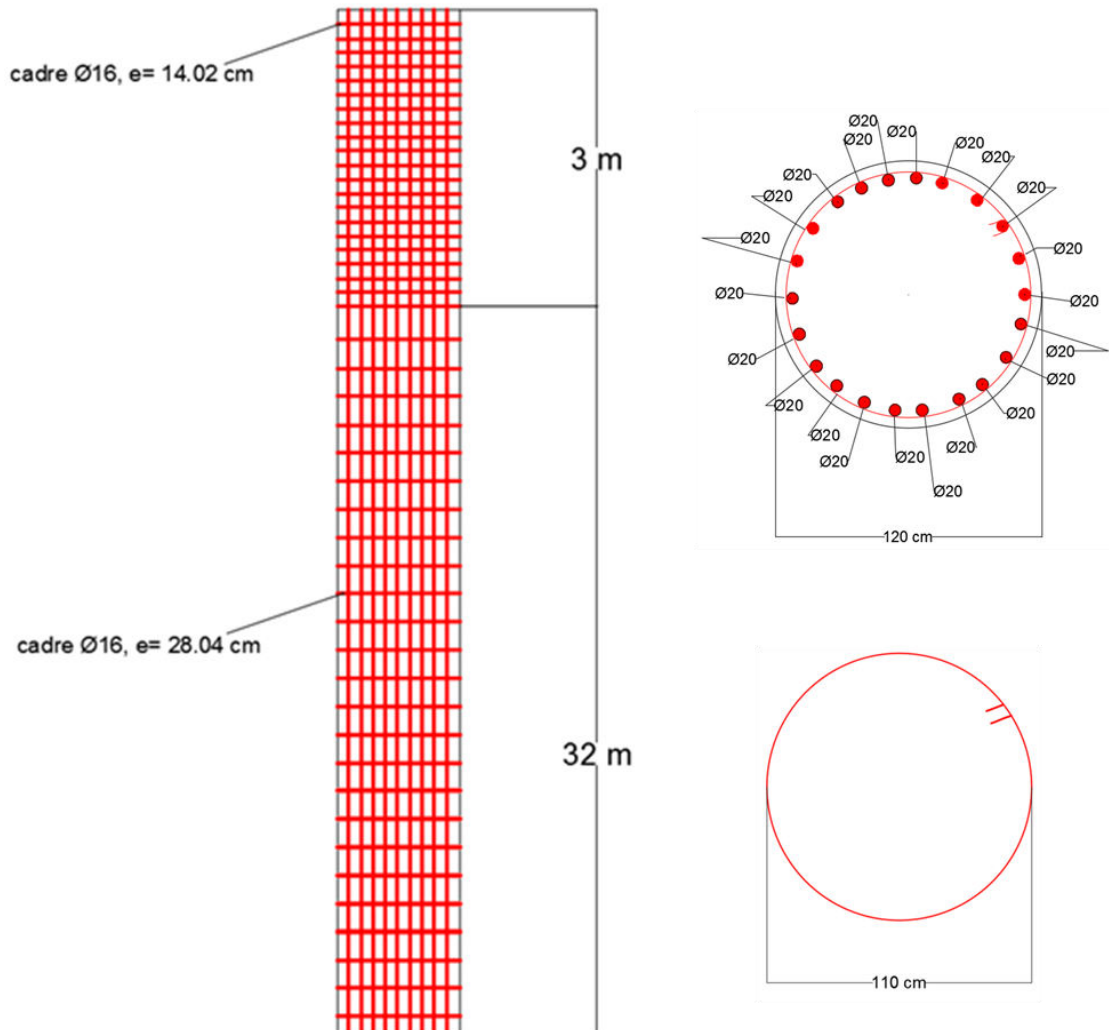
Schéma de ferrailage du pieu (élévation et coupe)
